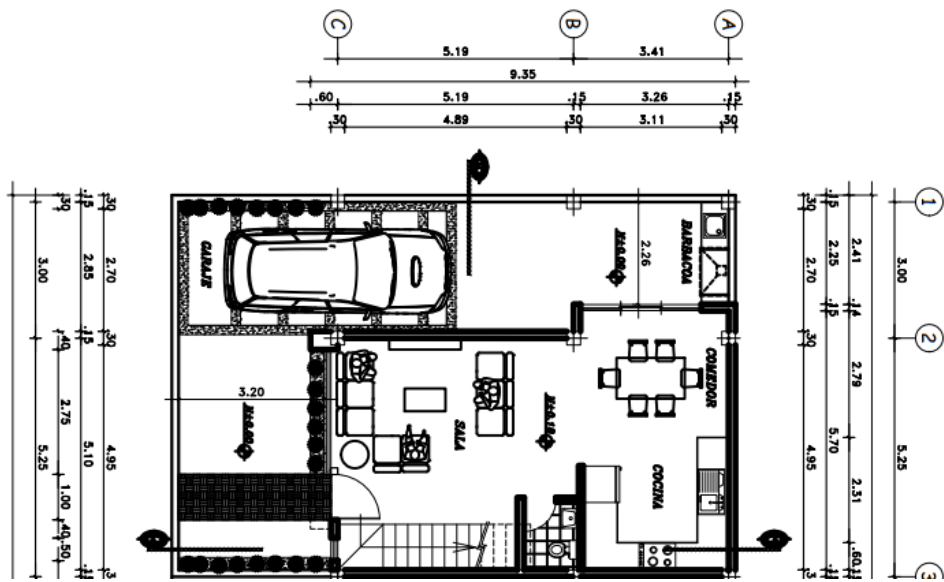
PLANO ARQUITECTÓNICO PLANTA BAJA CASA TIPO
